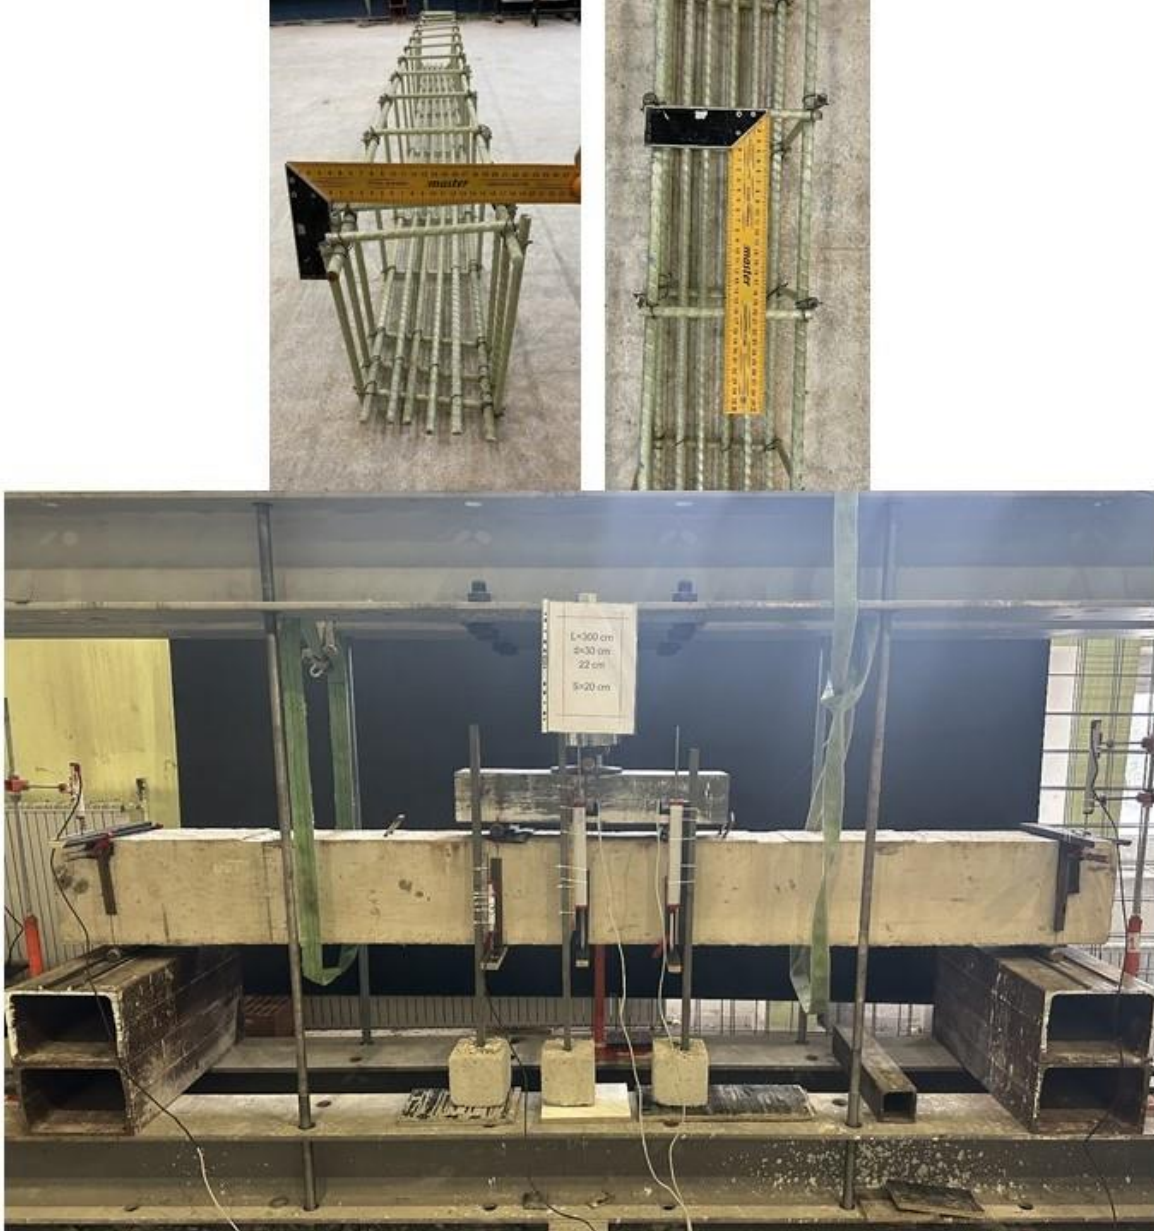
S-100-3.8 deney elamanı ve elemanın donatı detayları
